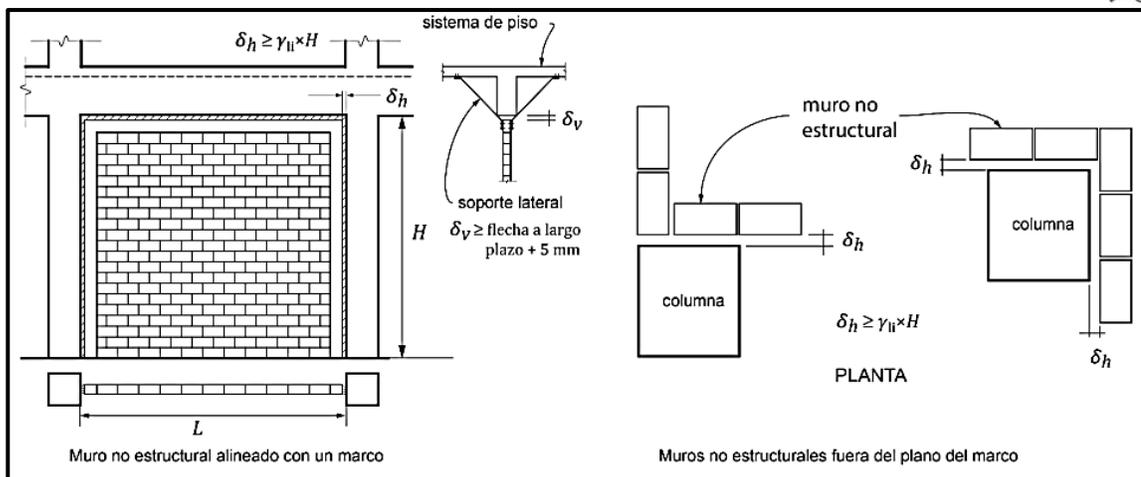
Holguras entre muros no estructurales y vigas. Fuente NTC 2017 Mampostería.
